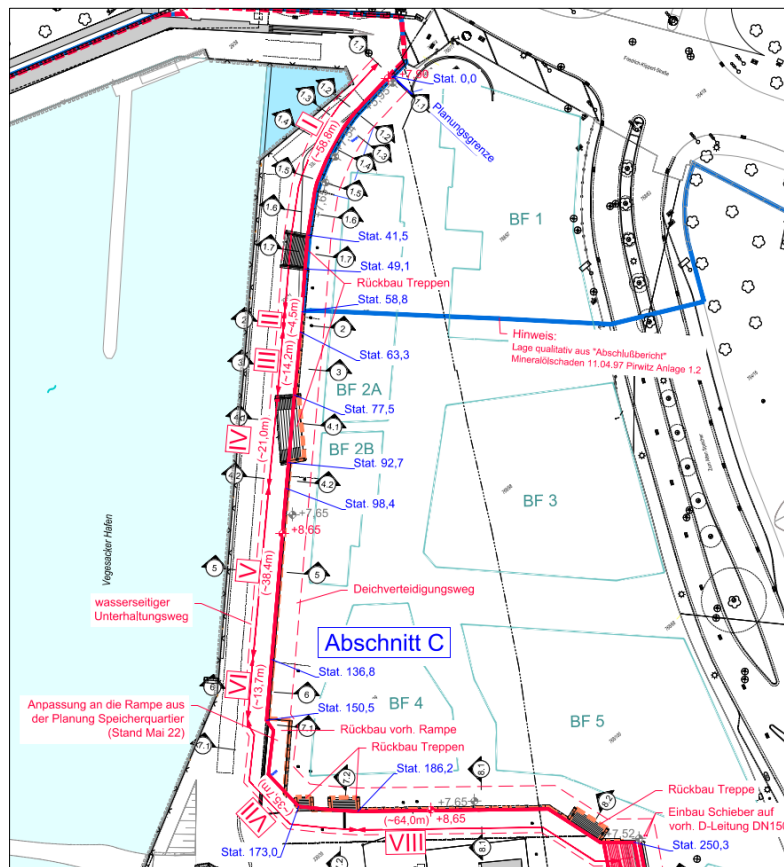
Ausschnitt Lageplan HWS-Maßnahme (LP 011)
